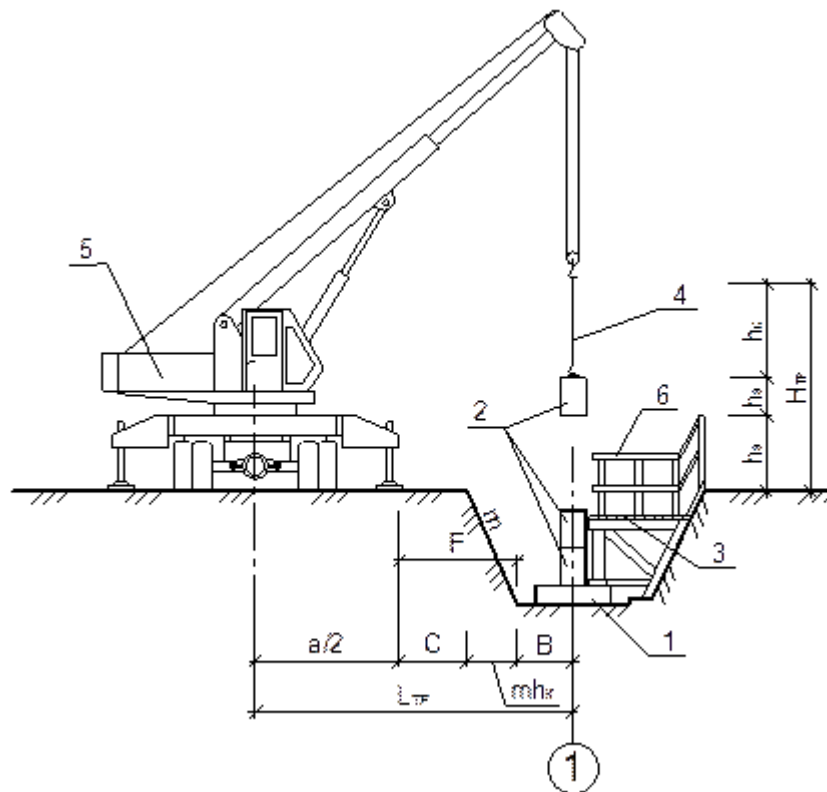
Схема к определению  $H_{тр}$  и  $L_{тр}$  при монтаже сборных фундаментов: 1 – фундаментная плита; 2 – фундаментный блок; 3 – рабочий настил; 4 – строп; 5 – автокран; 6 – защитное ограждение
